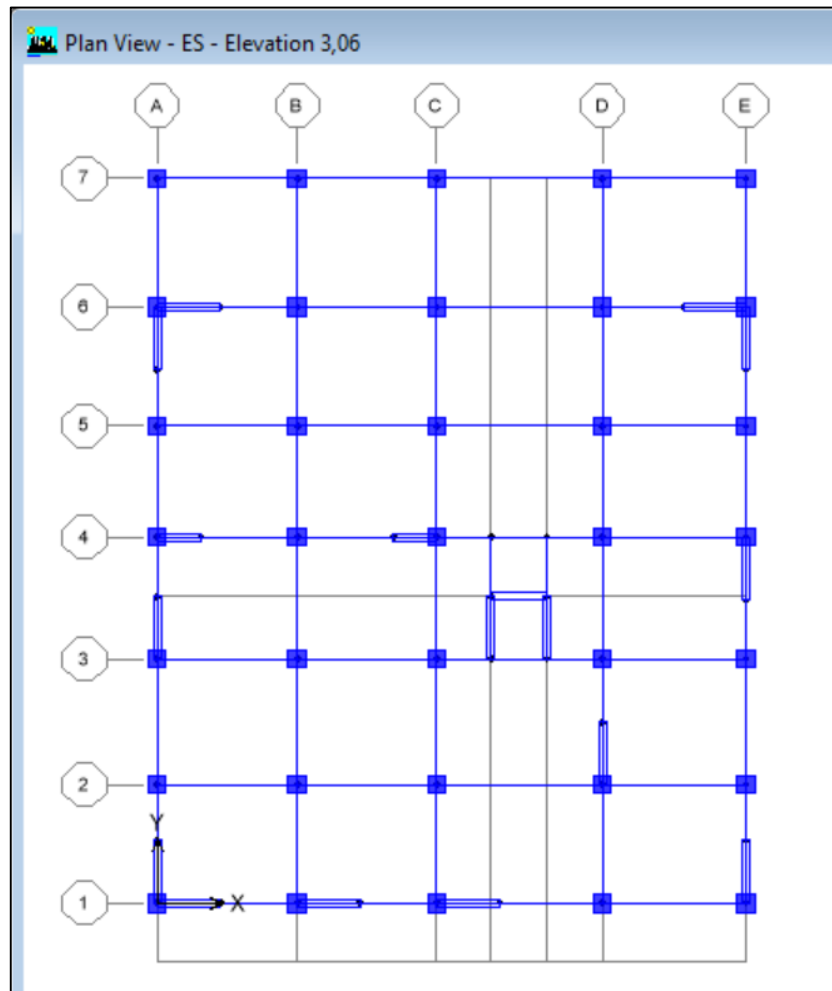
Vue en plan des éléments structuraux d'un étage
